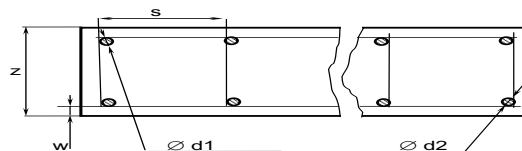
Схема перерізу несучої залізобетонної стіни
